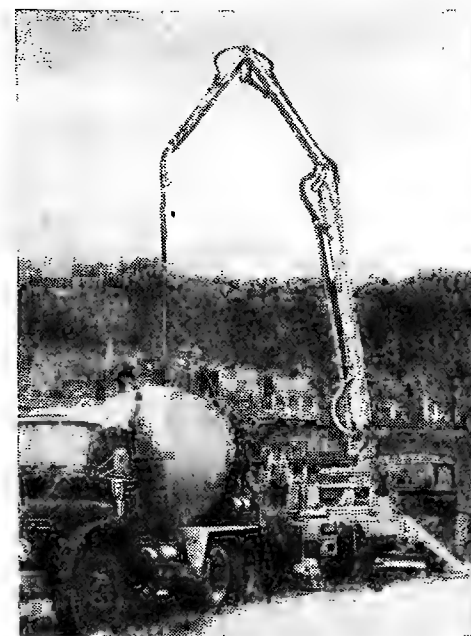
Укладка бетонной смеси с помощью бетононасоса в подпорную стену
